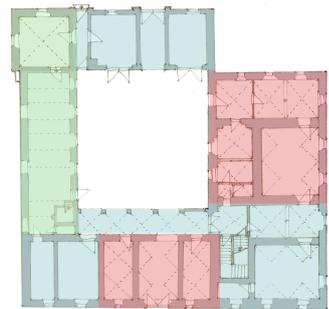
Bauplan Ende des 18. Jahrhunderts
